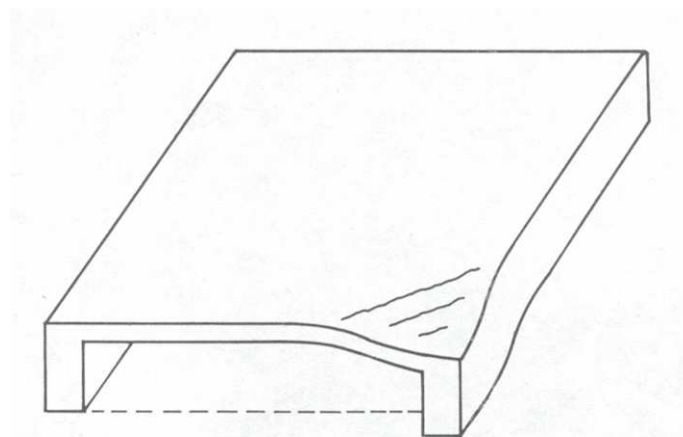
Trincas inclinadas devidas à torção da laje.
